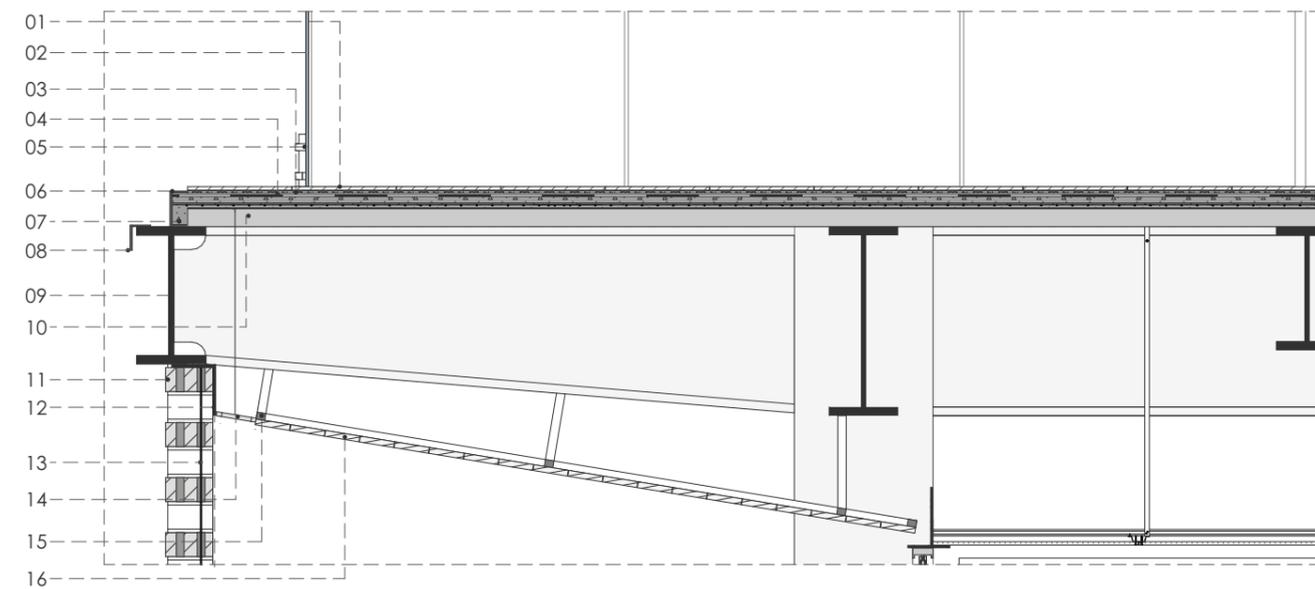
Detalle 03 - cubierta Fuente: Propia, 2022
